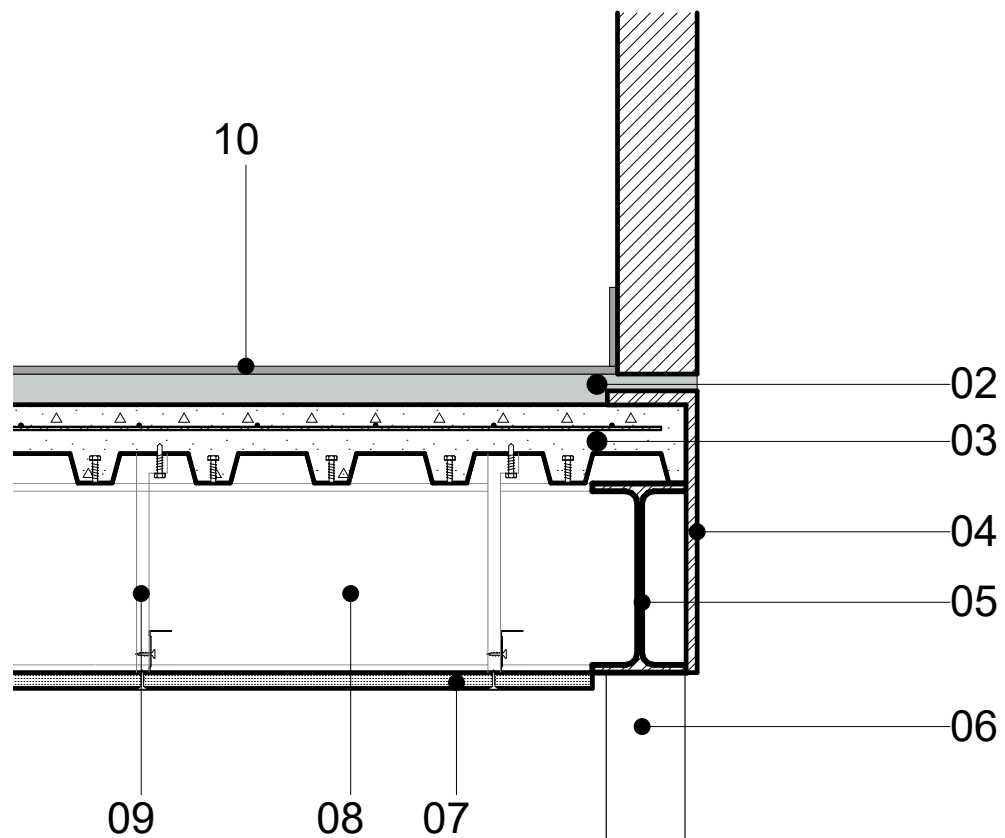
Detalle constructivo 02 Fuente: Elaboración Propia
